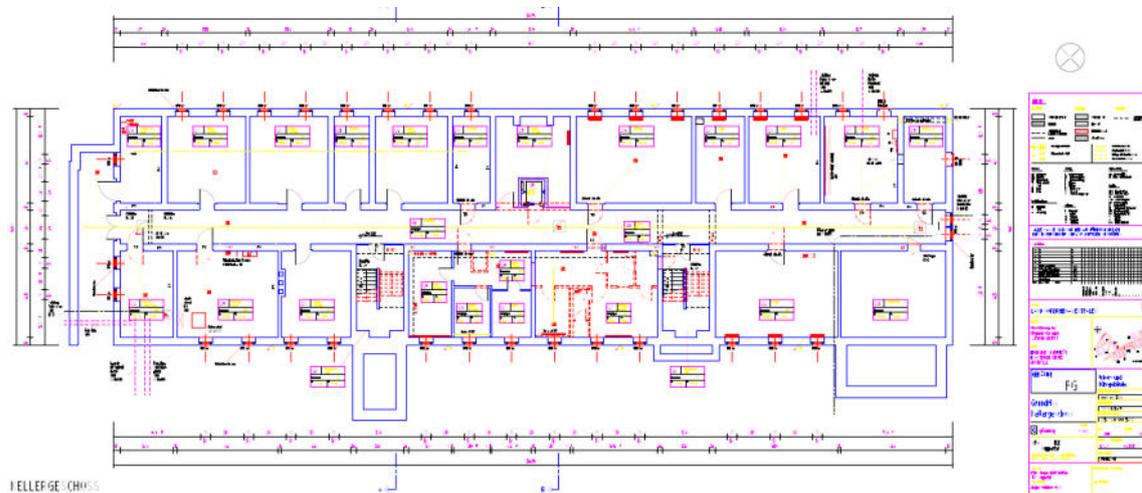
Grundrissplan Kellergeschoss, Gebäude FG
